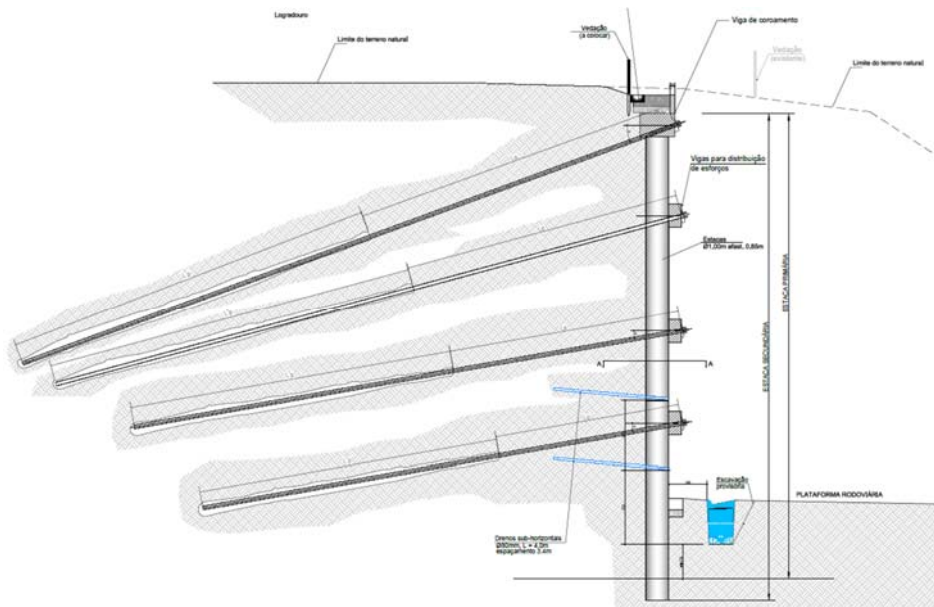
Secção tipo da estrutura de contenção em estacas e ancoragens
